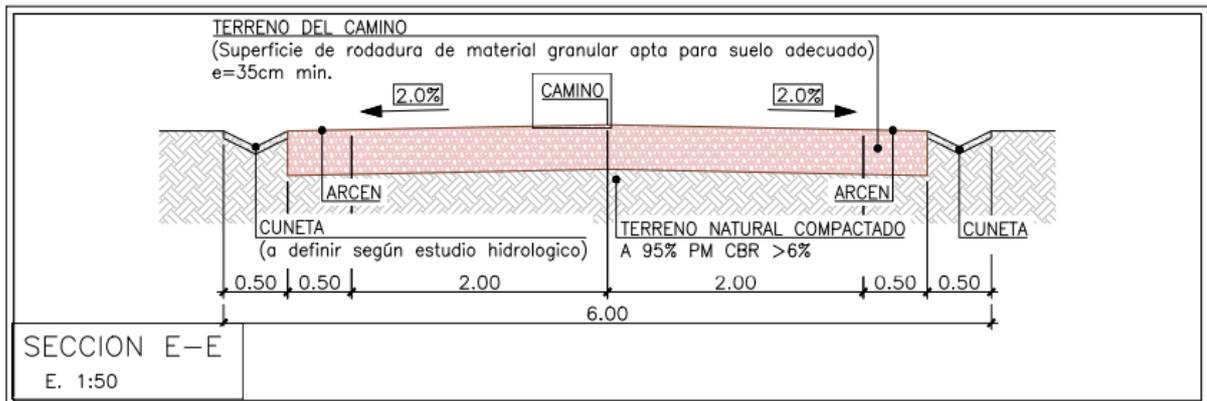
c. Sección tipo de viales. Fuente: Proyecto Técnico.
